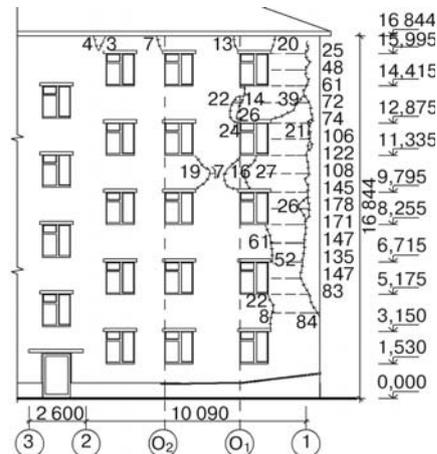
Исполнительная схема трещин в наружной продольной стене с указанием ширины их раскрытия (мм).
